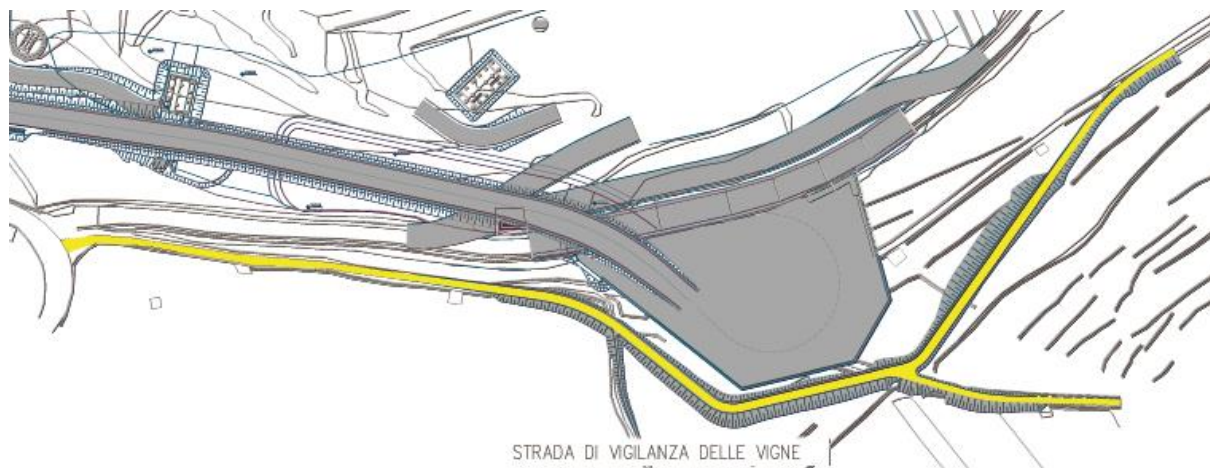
Stralcio planimetrico Strada di vigilanza delle Vigne
